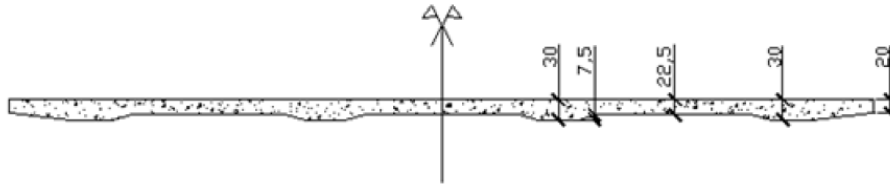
Seção transversal da laje de concreto armado (TOLEDO, 2011)
